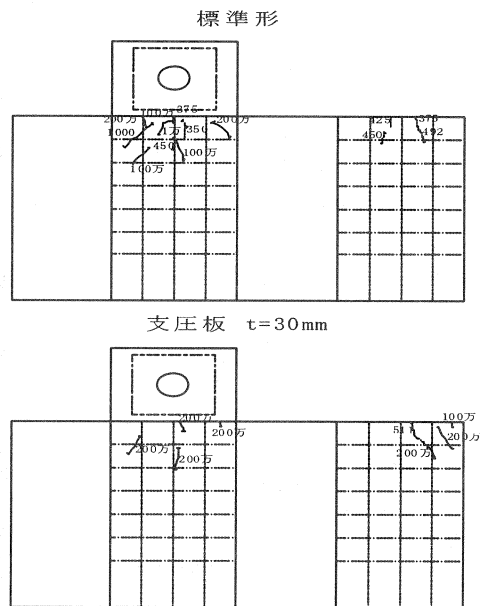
ひび割れ発生荷重 (ゲージ値)
